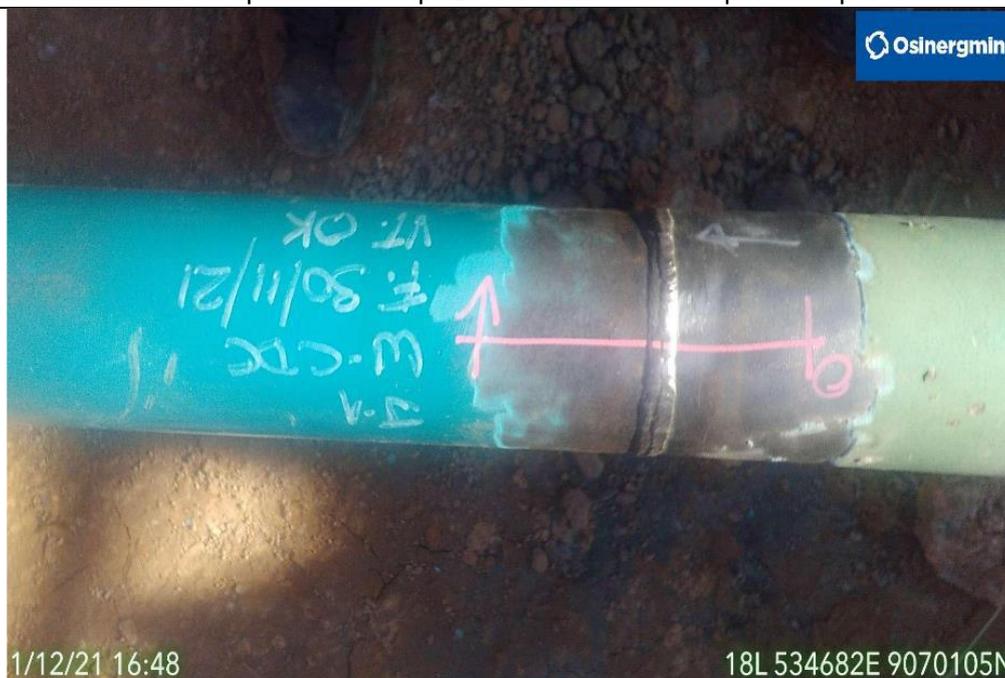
Vista de sección del ducto reemplazado en el KP 80+780 del tramo Estación Neshuya – Planta Fraccionamiento, se aprecia junta soldada aprobada.
